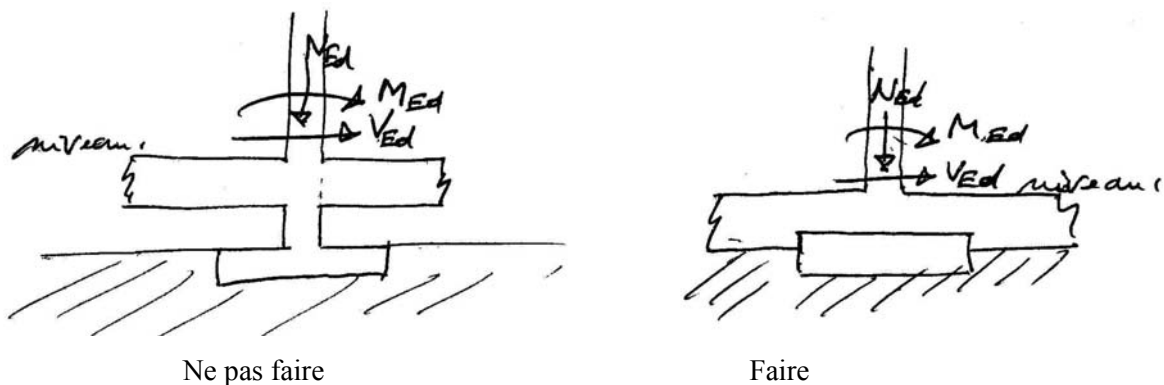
Les poteaux courts entre poutres de liaison et semelle sont à éviter.
